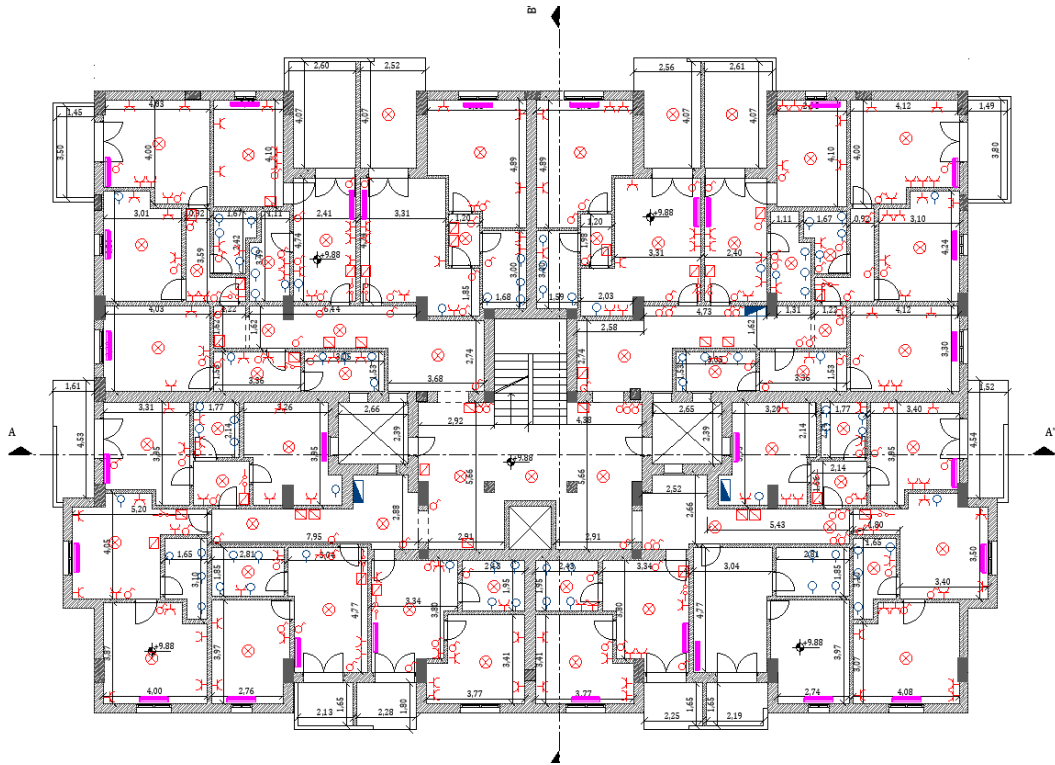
Dispositivi impiantistici rilevati al piano tipo che si ripete per piano primo secondo e terzo.
